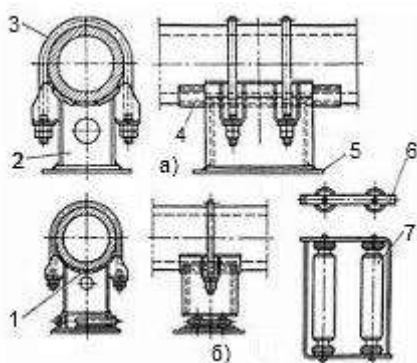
Типовые конструкции опор для трубопроводов.
